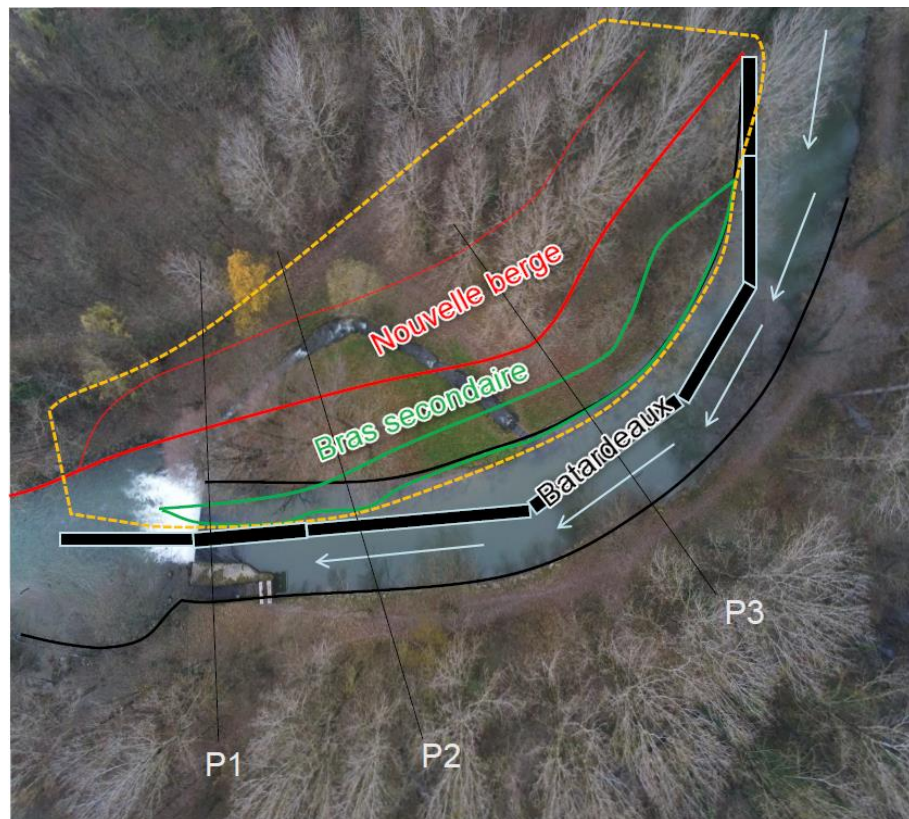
Étape 2 des travaux dans le secteur du seuil (construction de la rive droite)
